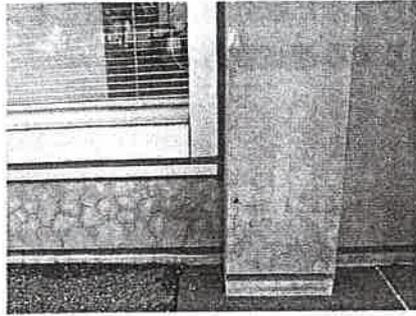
セメント系仕上げ（厚さ5mm）の外壁 写真2 屋根防水層の押えコンクリート
